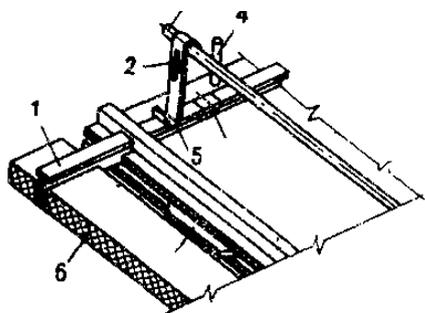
Устройство облицовки подвесных потолков плитками : 1 – направляющий профиль; 2 – подвеска; 3 – несущая арматура; 4 – стержень, заделанный в перекрытие; 5 – соединительная скоба; 6 – плитка подвесного потолка.
